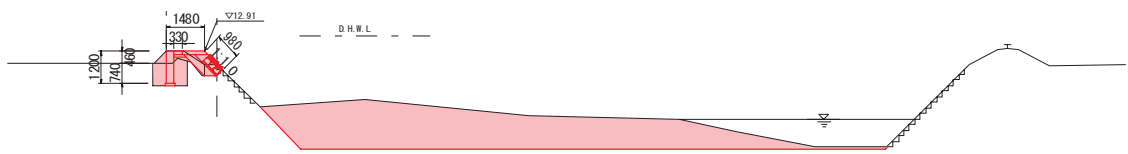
標準断面図（ぜい弱な既存施設の補強、障害物の除去）
